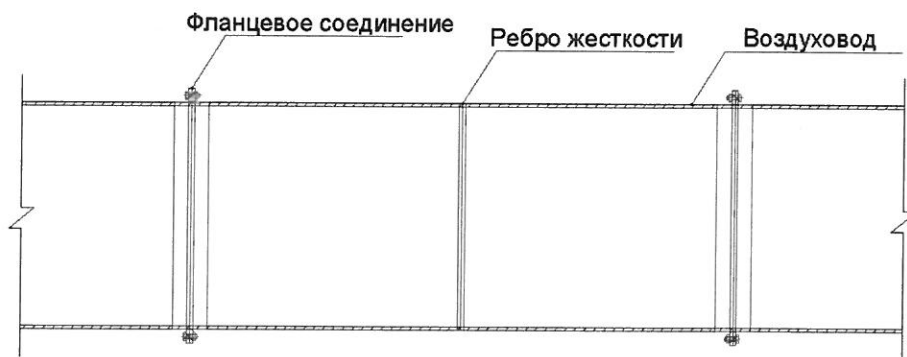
Принципиальная схема конструкции воздухопровода из оцинкованной стали на фланцевых соединениях
